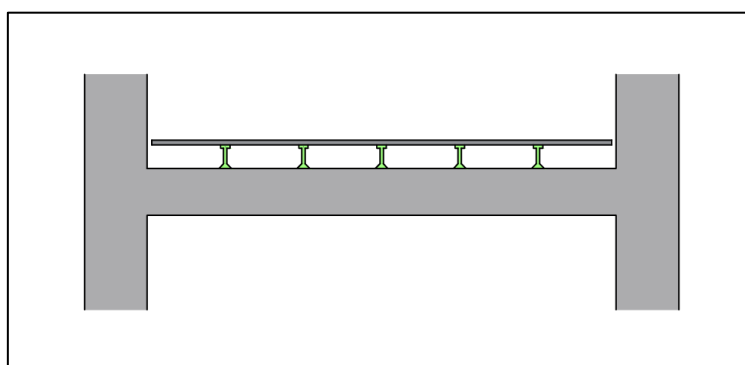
Schema grafico pavimentazione tecnica sopraelevata. Produzione propria
